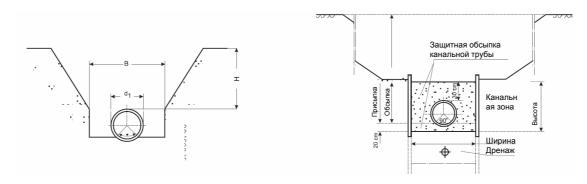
Форма траншеи с откосными стенами с опалубкой в канальной зоне
